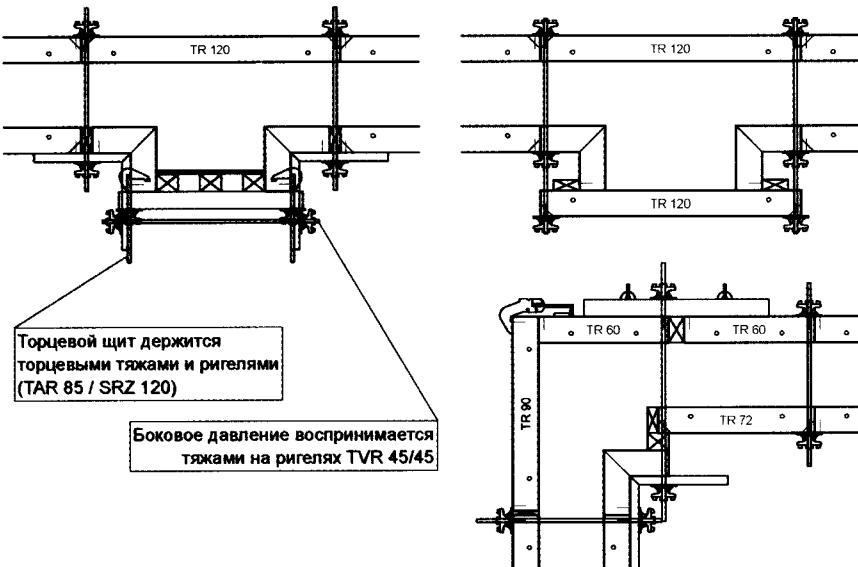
Раскладка элементов колонн, бетонируемых вместе со стенами
